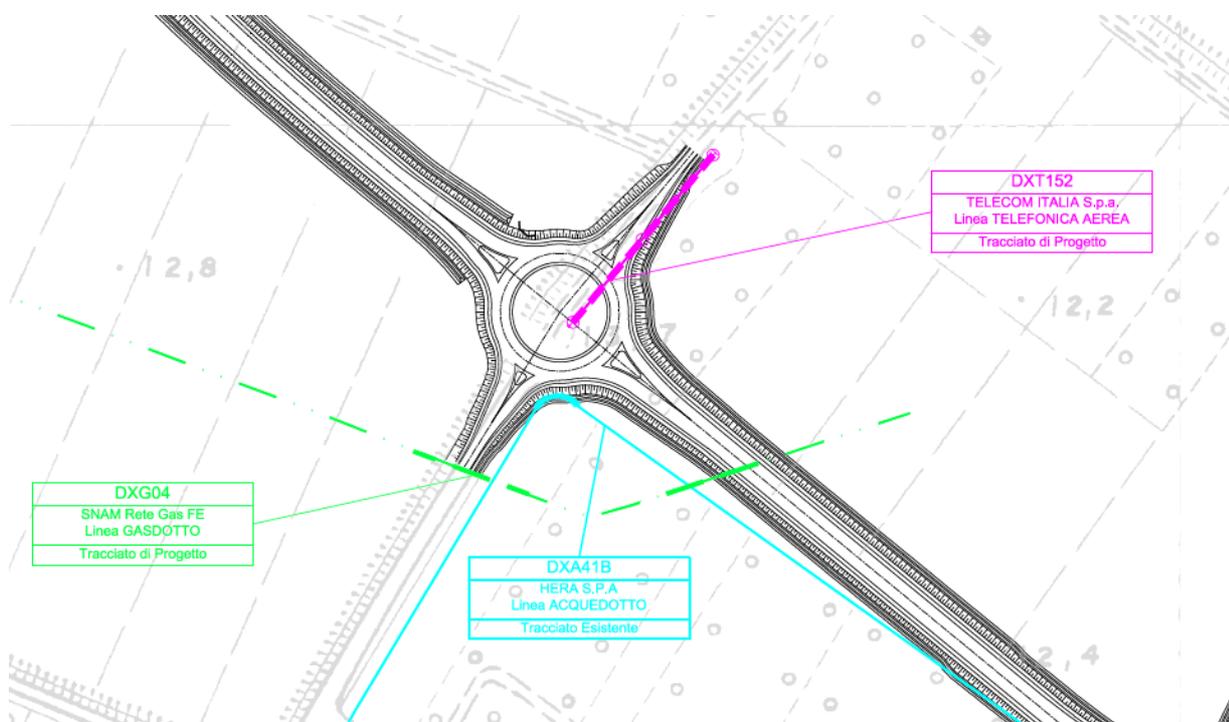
STRALCIO PLANIMETRICO PD
